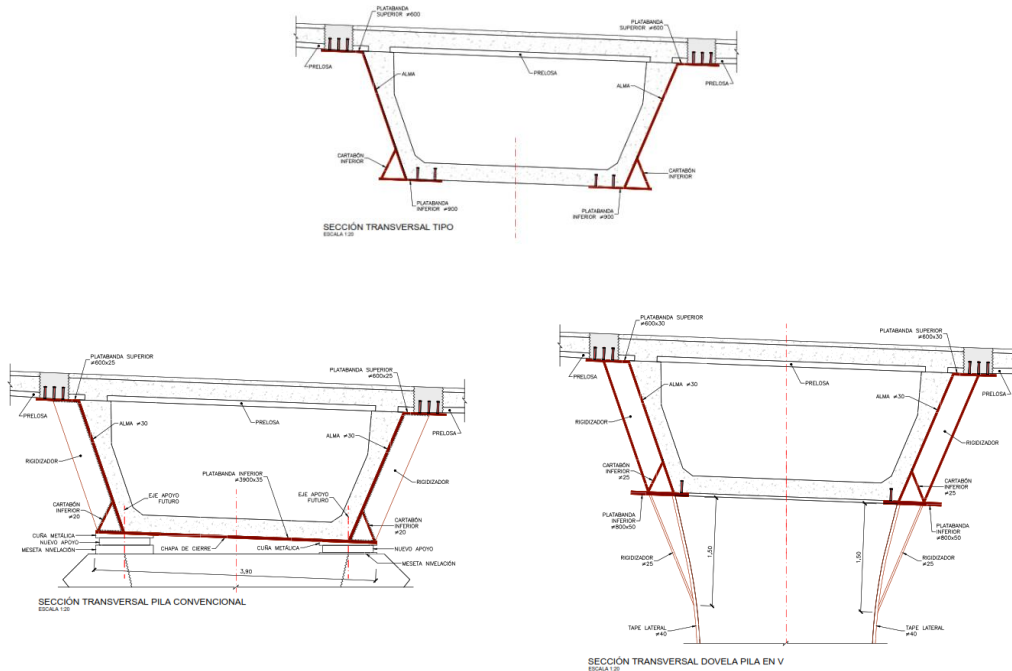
Semi sección metálica anexada con vinculación en losa superior y paramento inferior de viga artesa.
